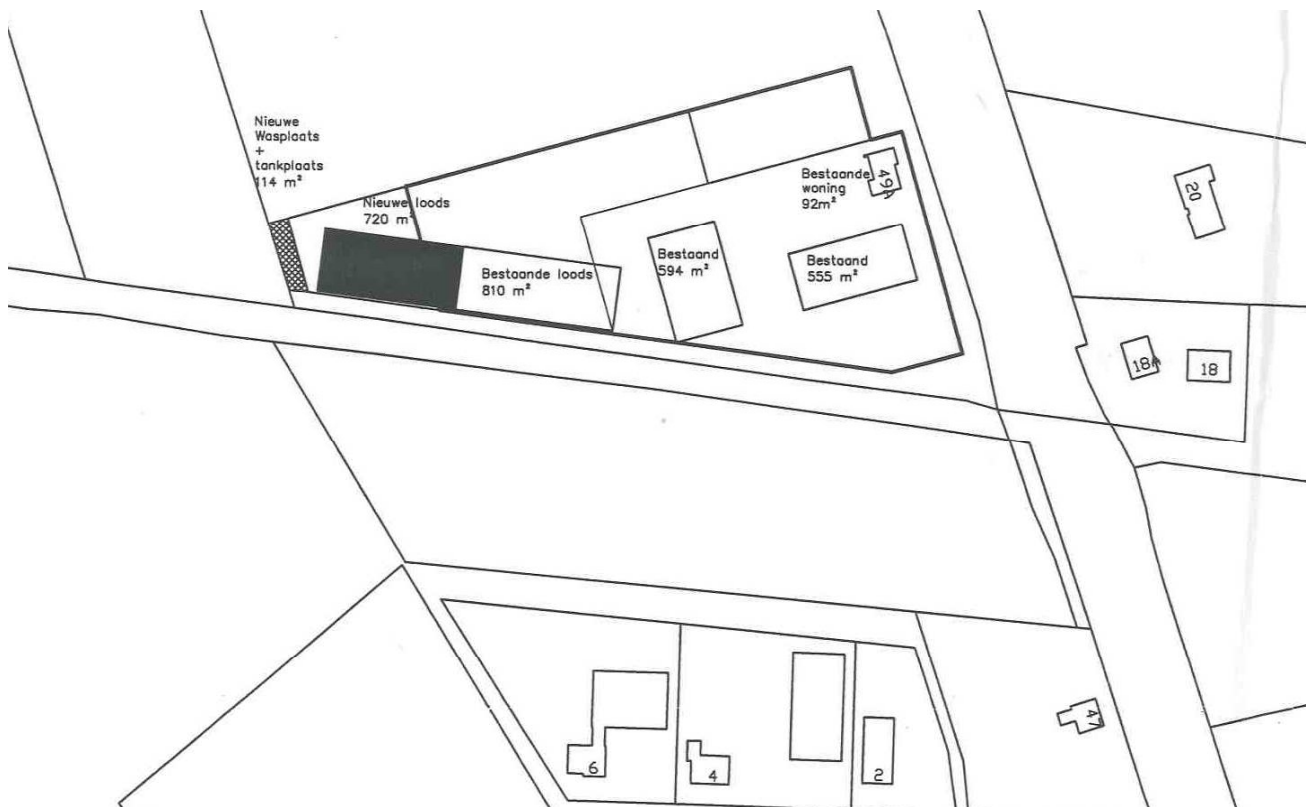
Bestaande situatie en geplande uitbreiding loods
